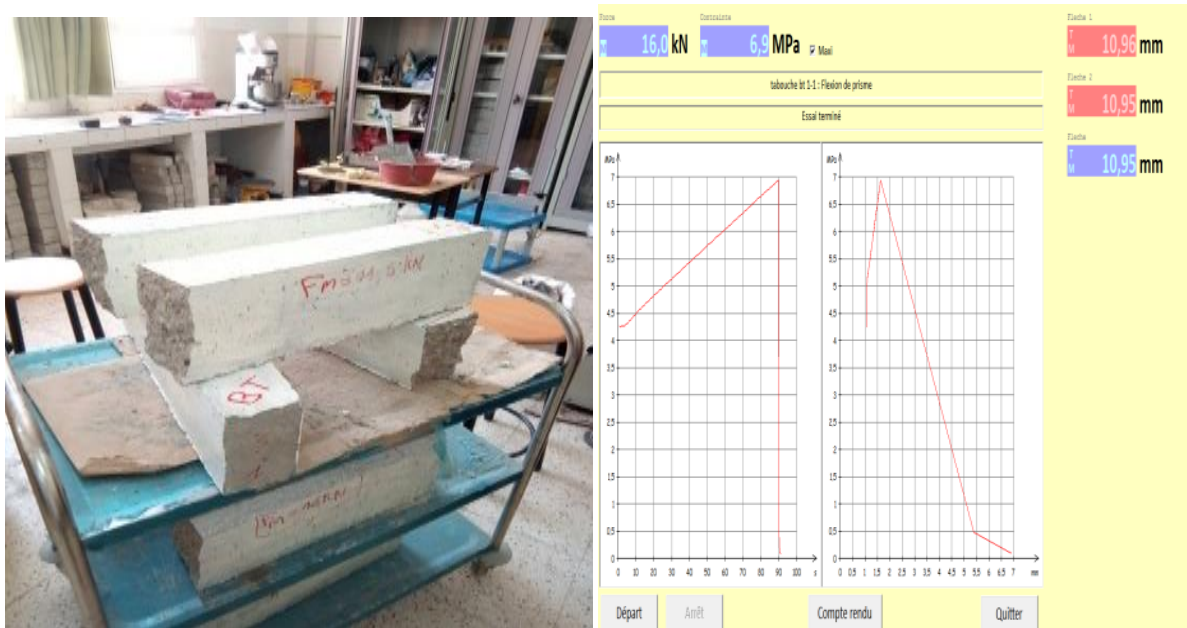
Photo et courbe de flexion de la poutre BO
